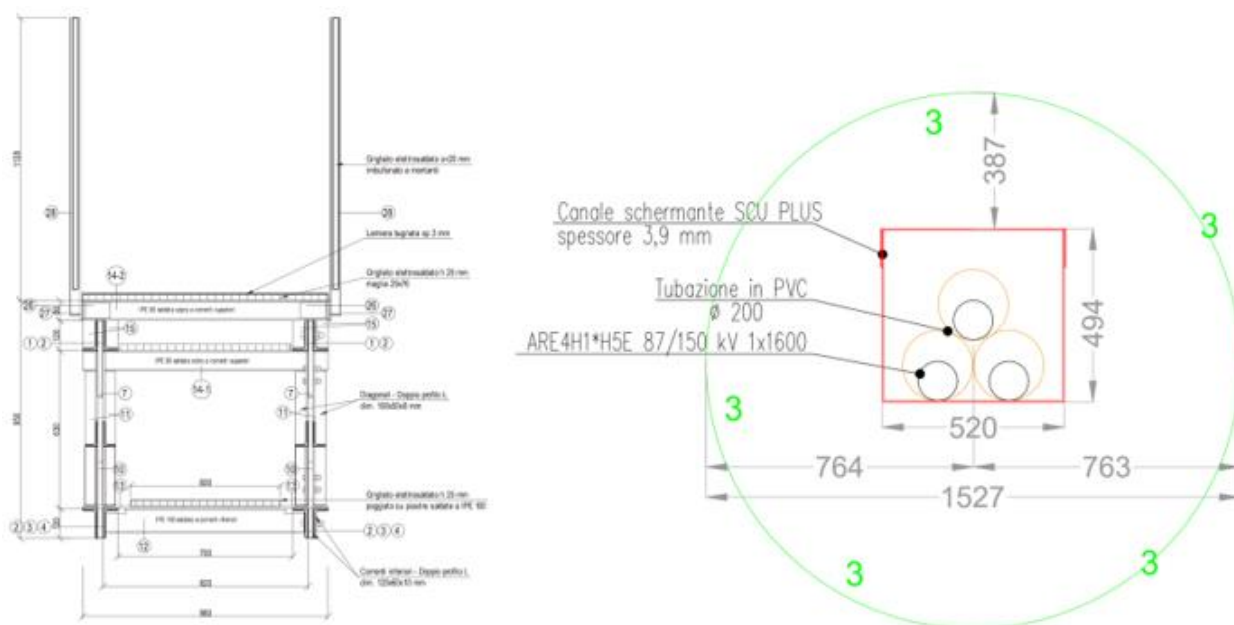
Sezione tipo nuovo cavidotto lungo ex trincea ferroviaria: a sx particolare della passerella tralicciata, a dx: disposizione dei conduttori, disposizione del canale schermante e DPA per il rispetto dei 3  $\mu$ T (Fonte: I-reti)
